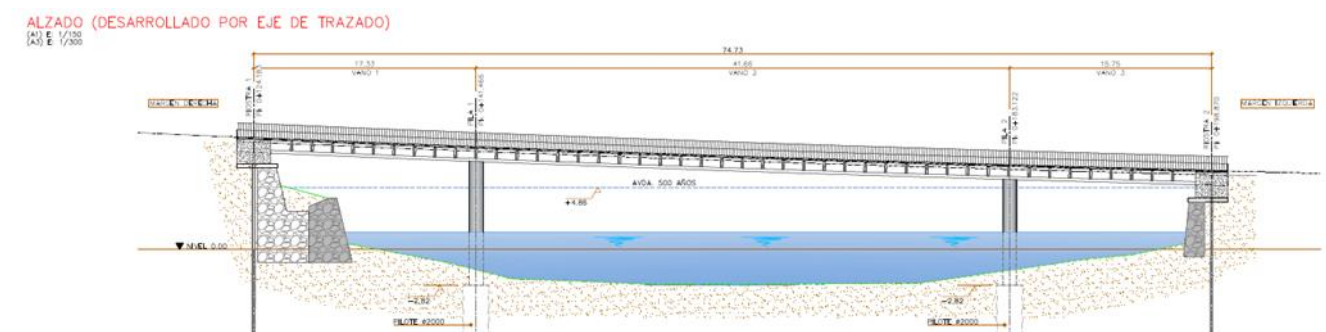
Plano alzado (Fuente: Proyecto de construcción)
